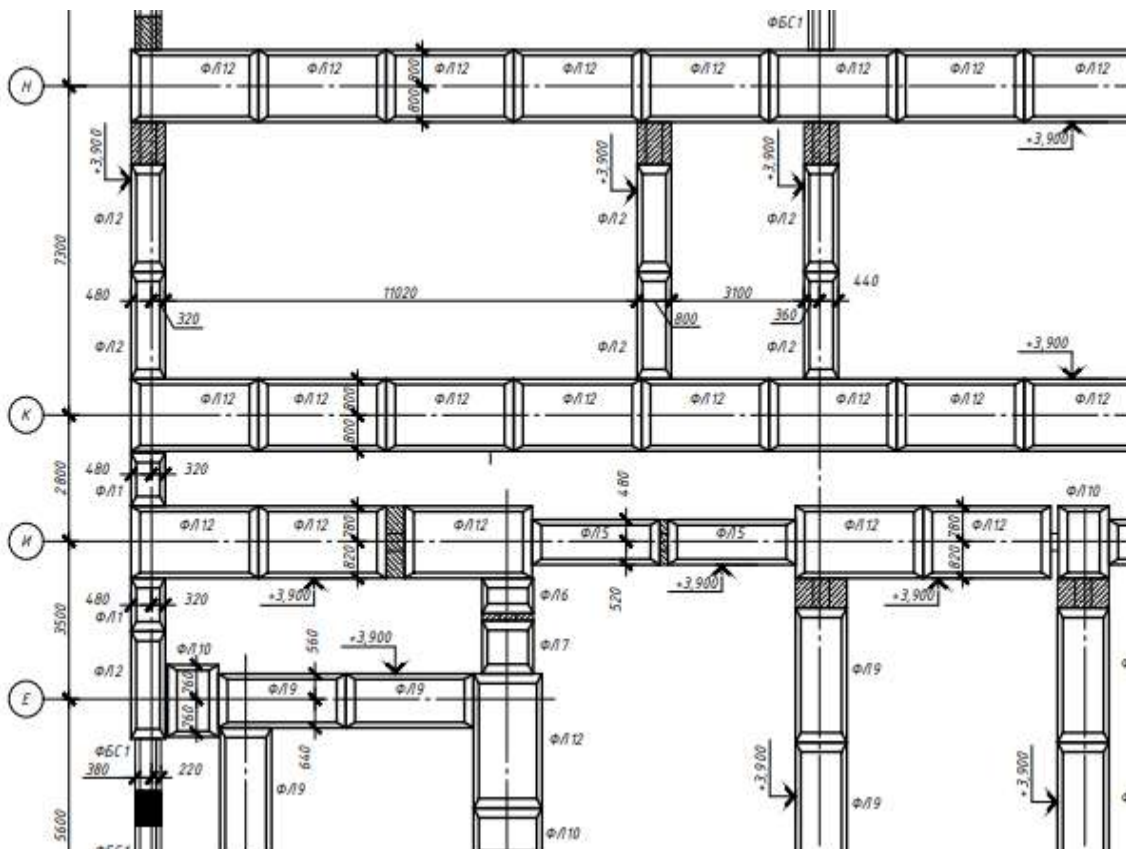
Фрагмент плана фундаментов из подосновы диплома
